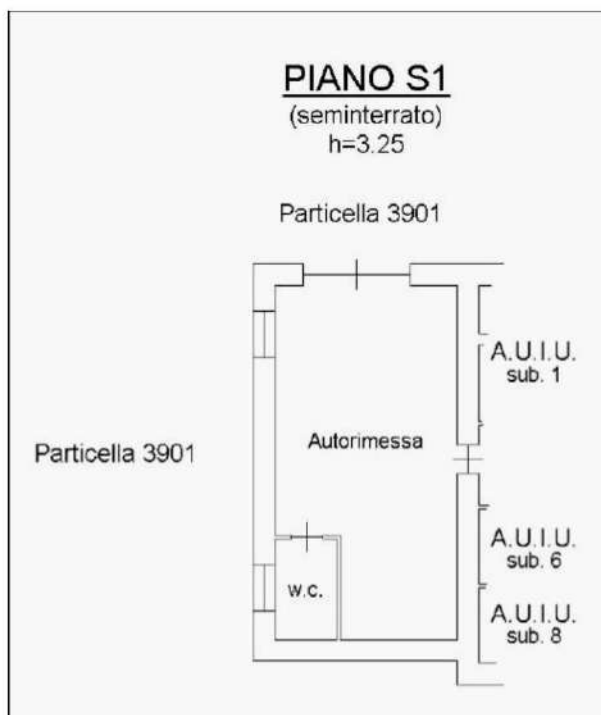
Planimetria catastale autorimessa (Sub. 2)
